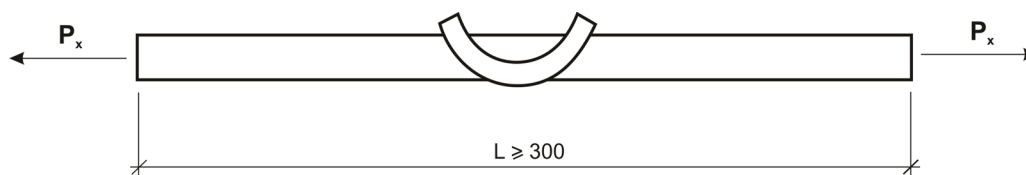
Схема испытания на растяжение продольного стержня нижнего пояса со сварным соединением
